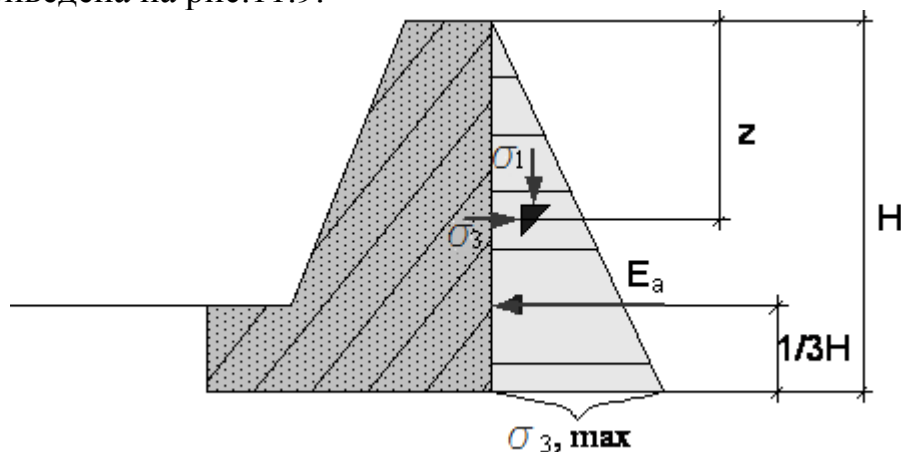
Расчетная схема подпорной стенки с идеально сыпучим грунтом засыпки
